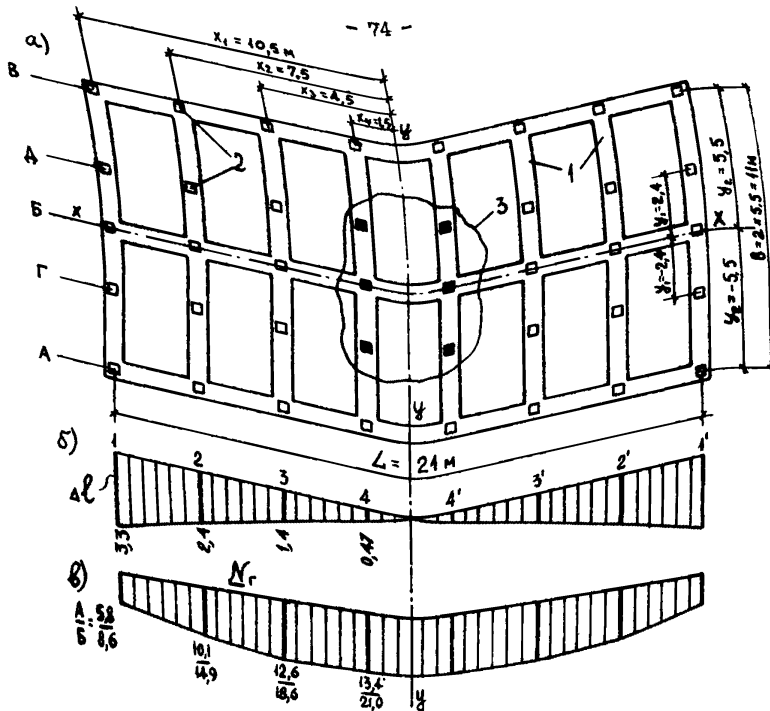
Схема свайного поля (а), эпюра горизонтальных перемещений грунта (б) и эпюра продольных усилий ростверке (в) под воздействием горизонтальных деформаций (в числителе под стенами А и В, в знаменателе - под стеною Б); 1-ростверг; 2-сваи с шарнирной заделкой голов в ростверк; 3-сваи с жесткой заделкой голов.
